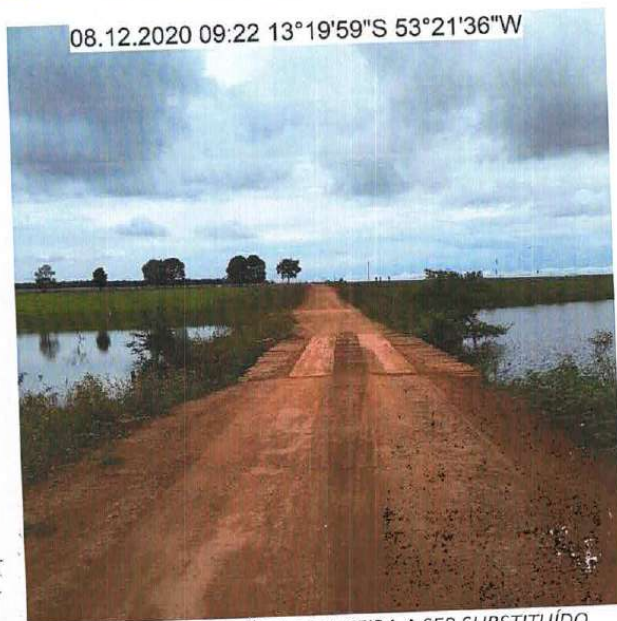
PONTILHÃO DE MADEIRA A SER SUBSTITUÍDO
